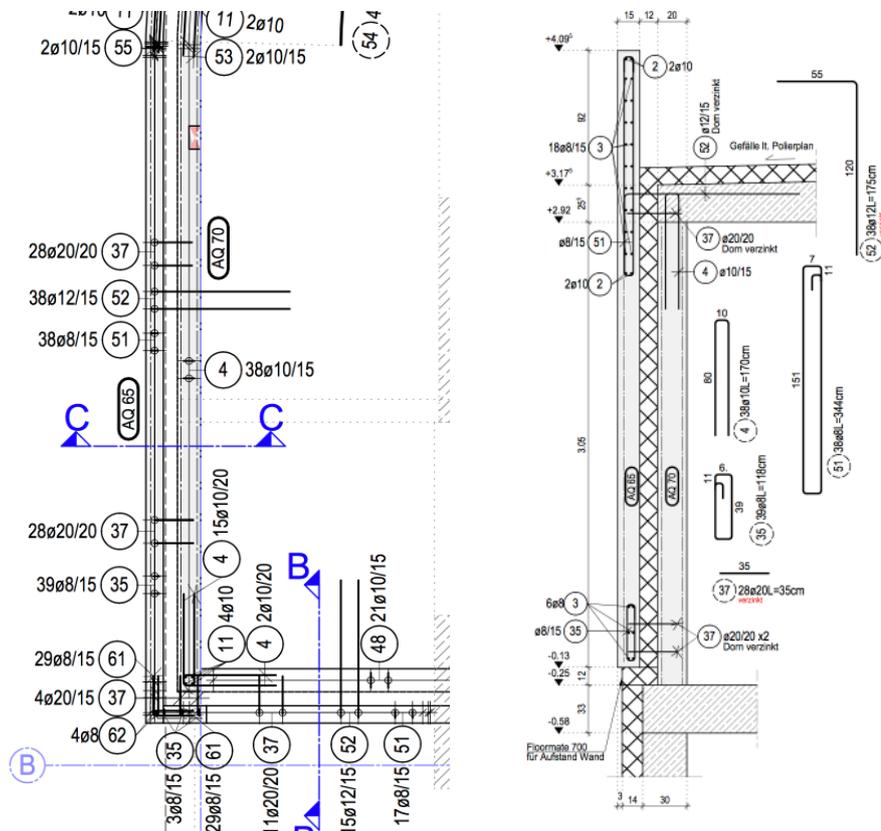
Bewehrungsplan Grundriss mit Schnitt C-C
